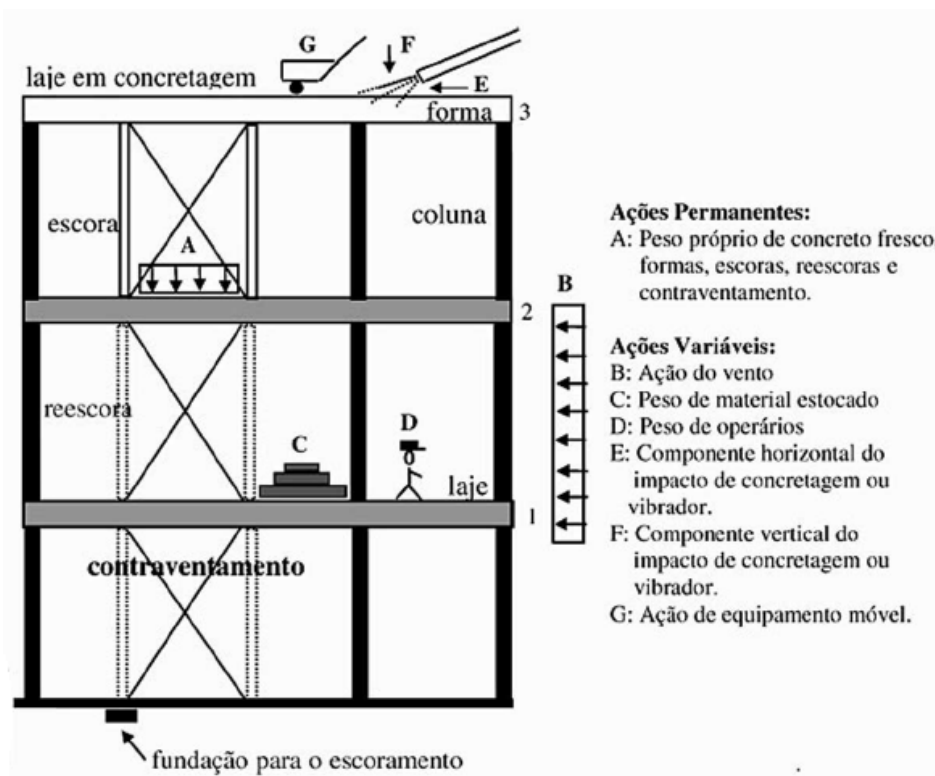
Principais ações de construção em um edifício de três pavimentos (NAPOLEÃO FILHO, 1998)
